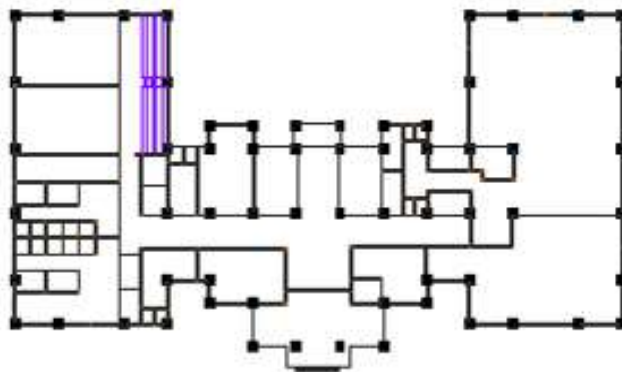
Bentuk Bangunan Olahraga Indoor
